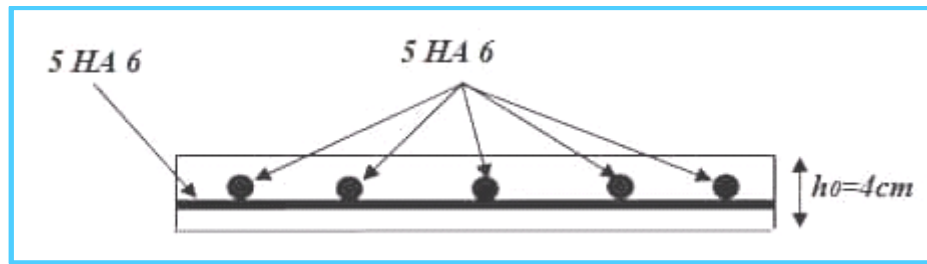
Coupe de schéma de ferrailage de la table de compression.
